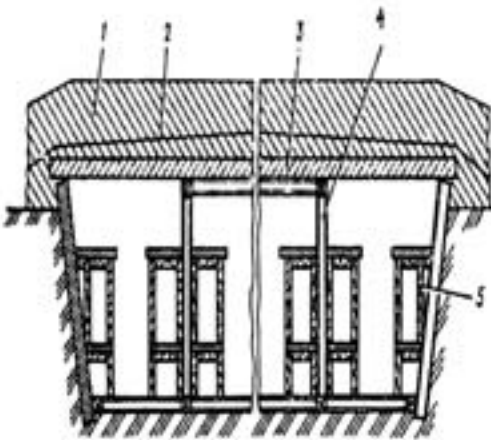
Трипрогонове ШСС з похилими стінами із залізобетонних плит розпірної рами з дерева:
